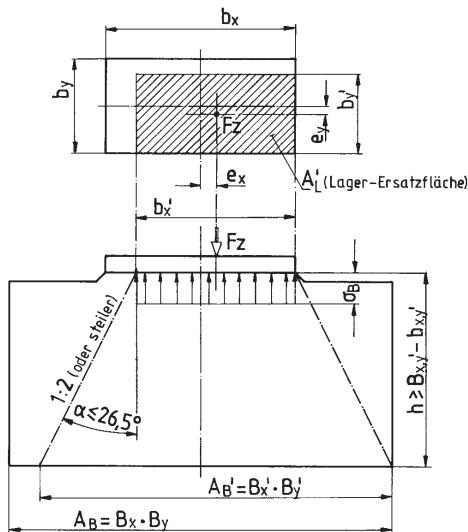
Lager- und Betonersatzfläche bei einer ausmittig belasteten rechteckigen Lagerplatte
